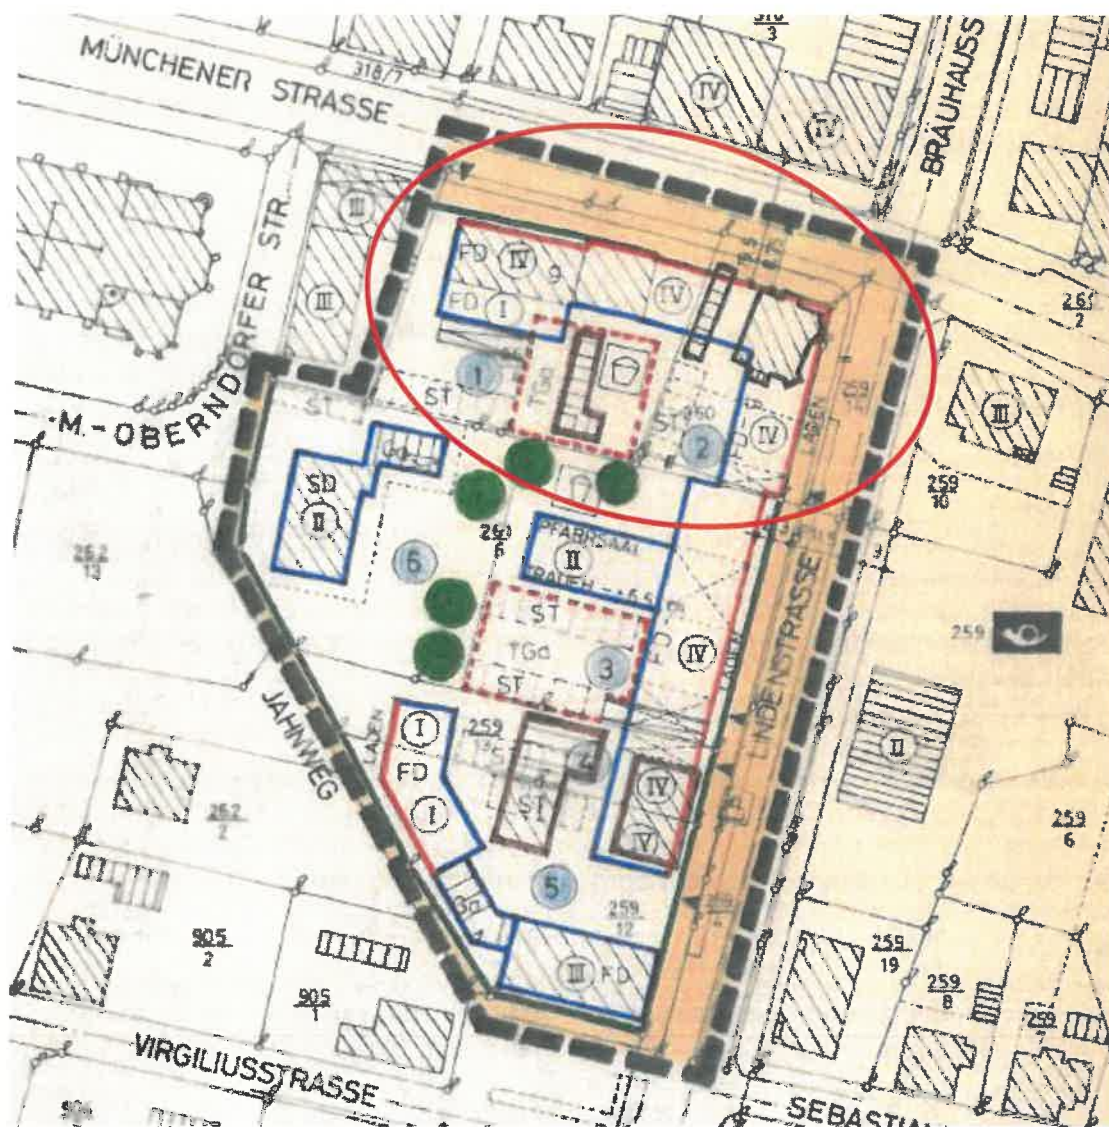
Bebauungsplan "Ecke Münchener - Lindenstraße" i. d. F. seiner 1. Änderung mit Rechtsverbindlichkeit seit 09.01.1975 (Planungsstandort: roter Kreis)
